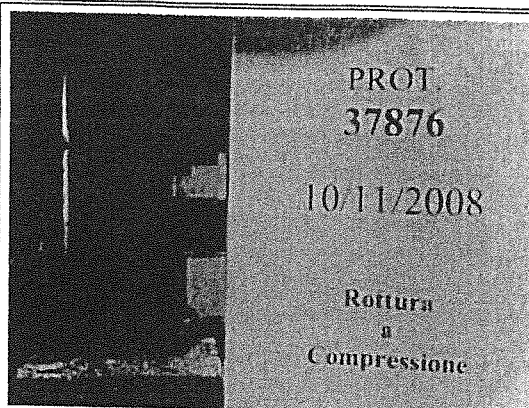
Vista della carota (PL2) durante la prova di rottura a compressione
